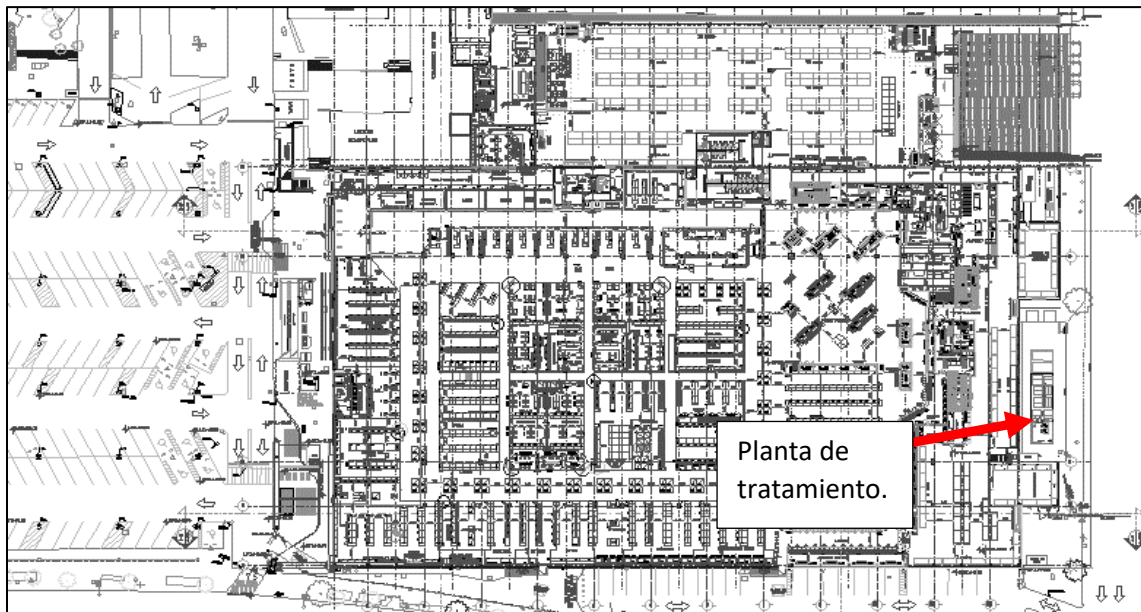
Ubicación de la planta de tratamiento. Plano ejecutivo.
